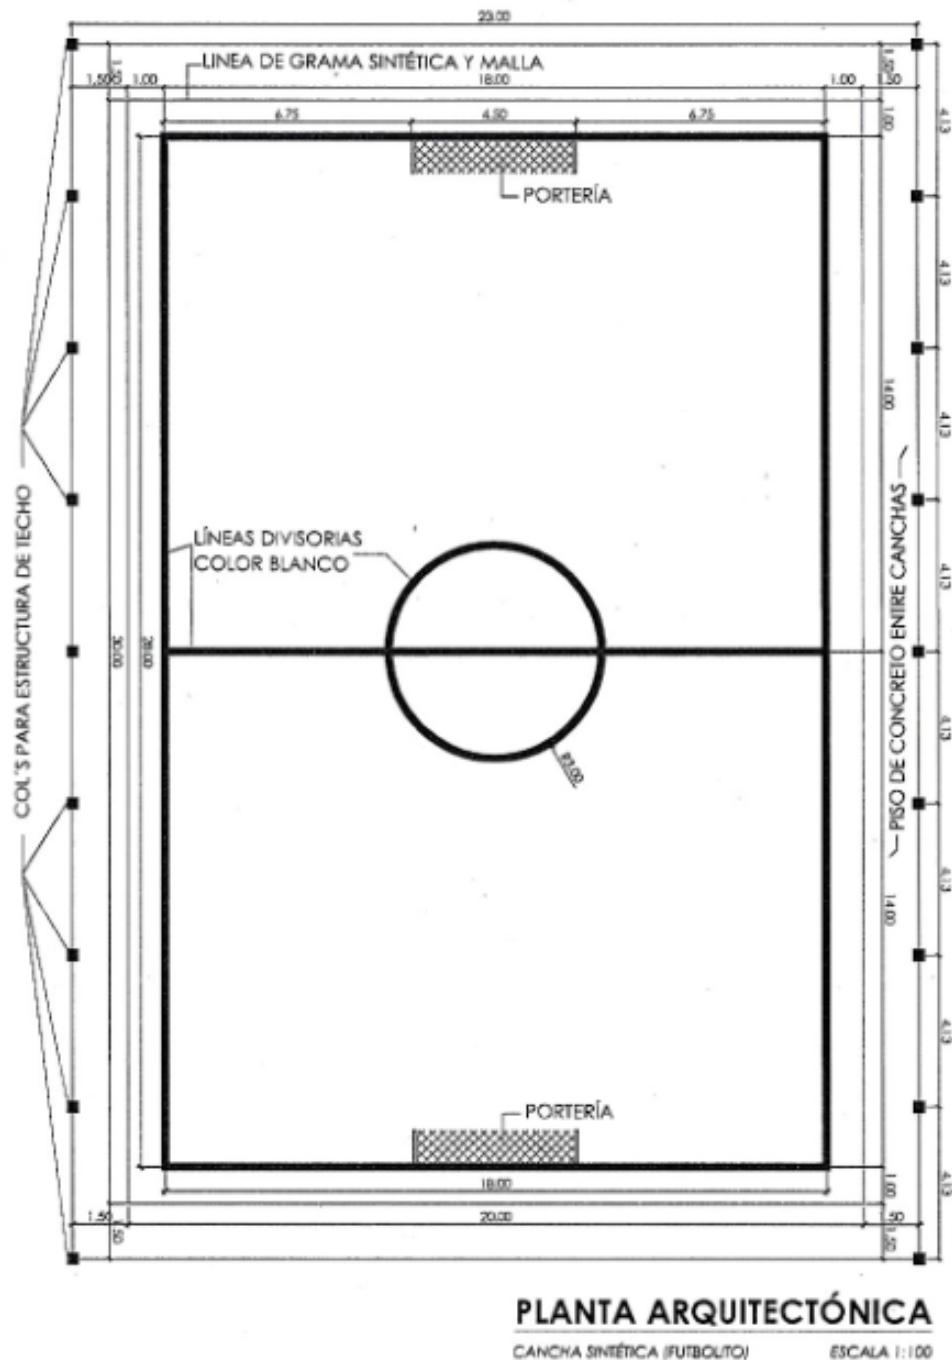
Planta arquitectónica Cancha sintética de futbolito
